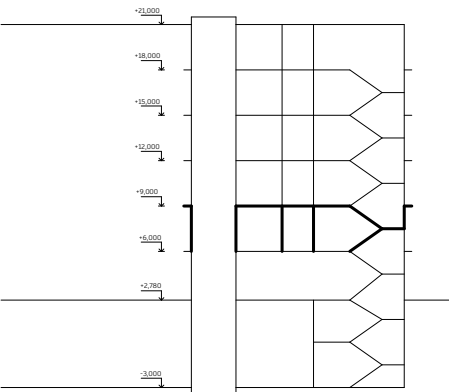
DETAIL ULOŽENÍ PREFA SCHODIŠTĚ M 1:50
